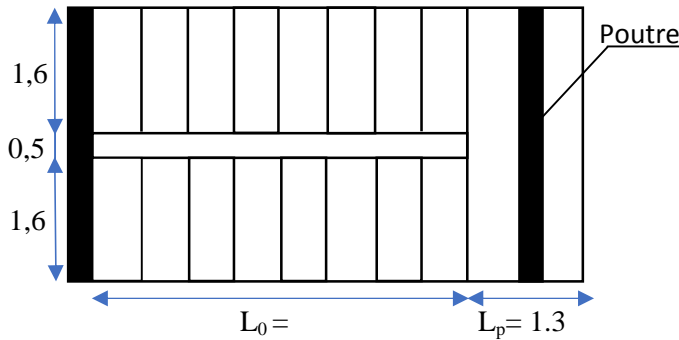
Vue en plan d'un escalier droit à deux
